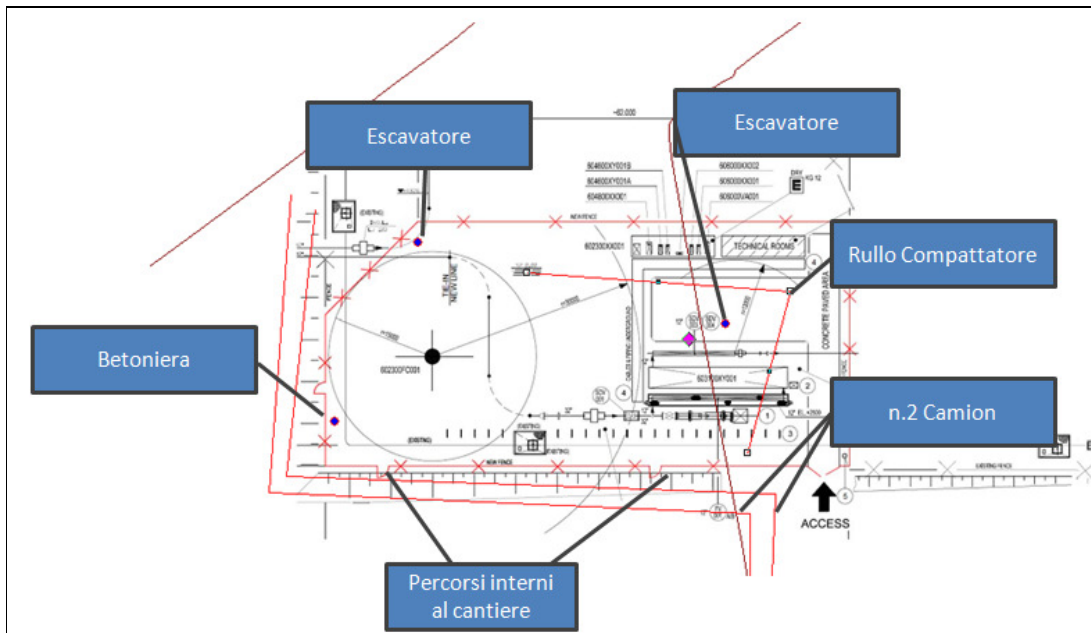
layout impianto con ubicazione sorgenti sonore
